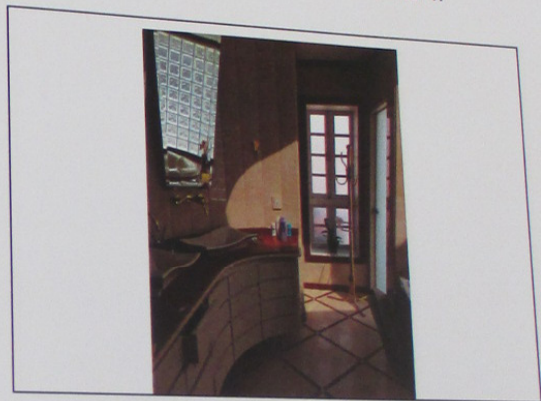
Vista do Banheiro da Suíte 4.
